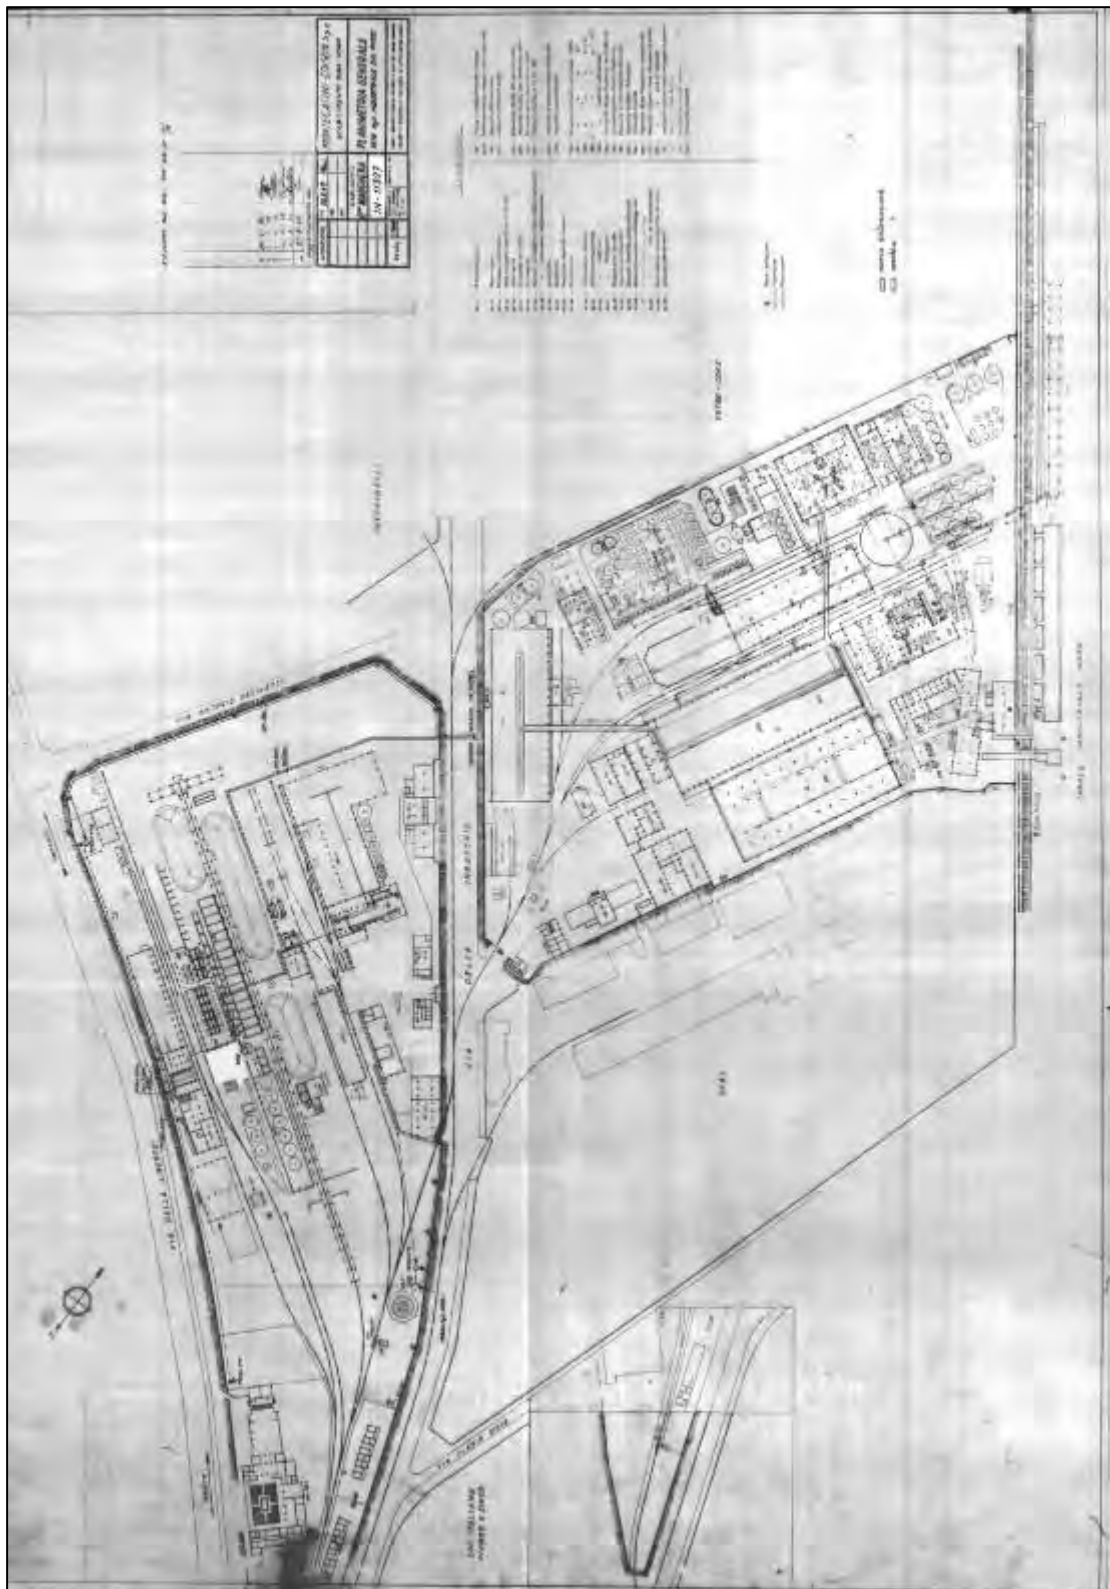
1965 (con aggiornamenti fino al 1970), Montecatini-Edison, planimetria generale stabilimento DIPA Nord scala 1:1000 con tracciato impianto acqua industriale (fonte: lucido originale archivio Fertimont)
